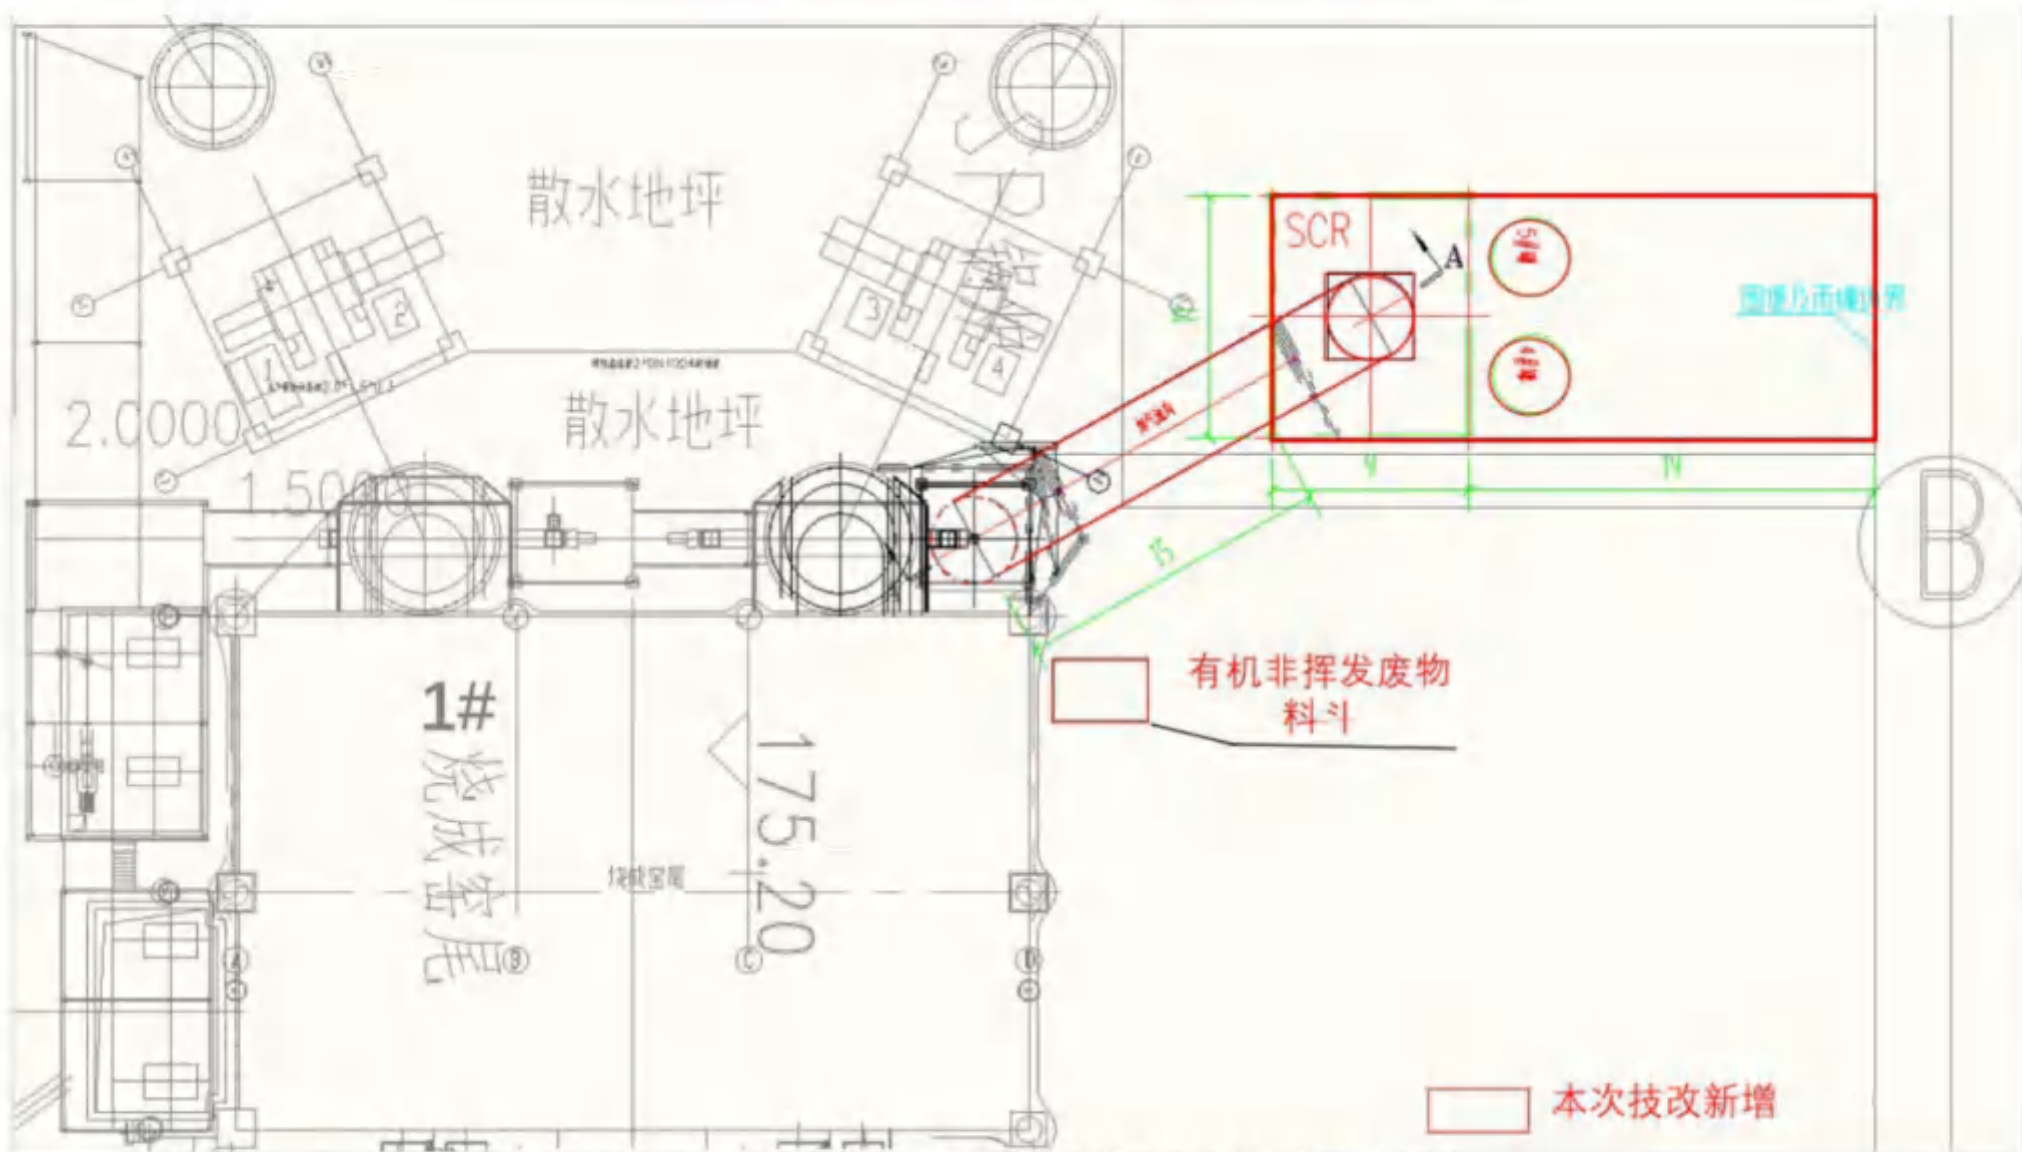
技改项目新增 1#线半固态危废暂存和进料系统平面布置图
